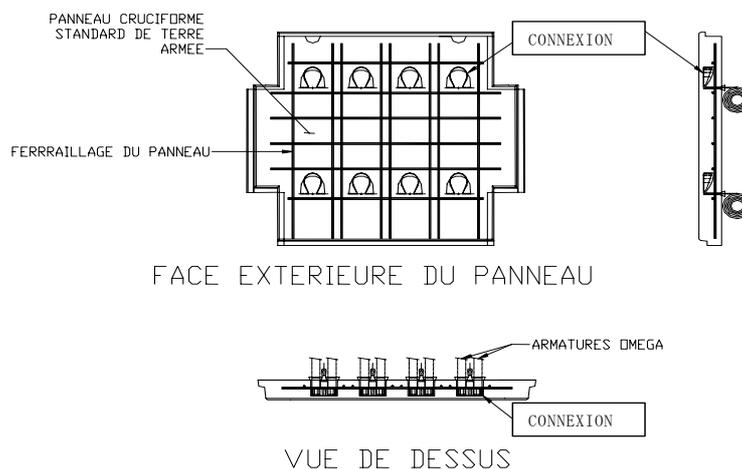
Plan de principe : panneau standard avec armatures et connexions
